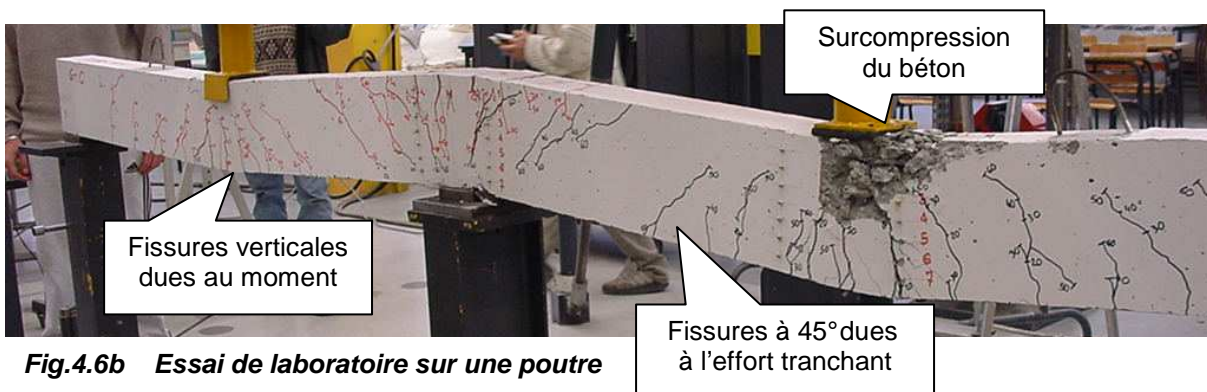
Modes de rupture d'une poutre sur 2 appuis sollicitée en flexion
